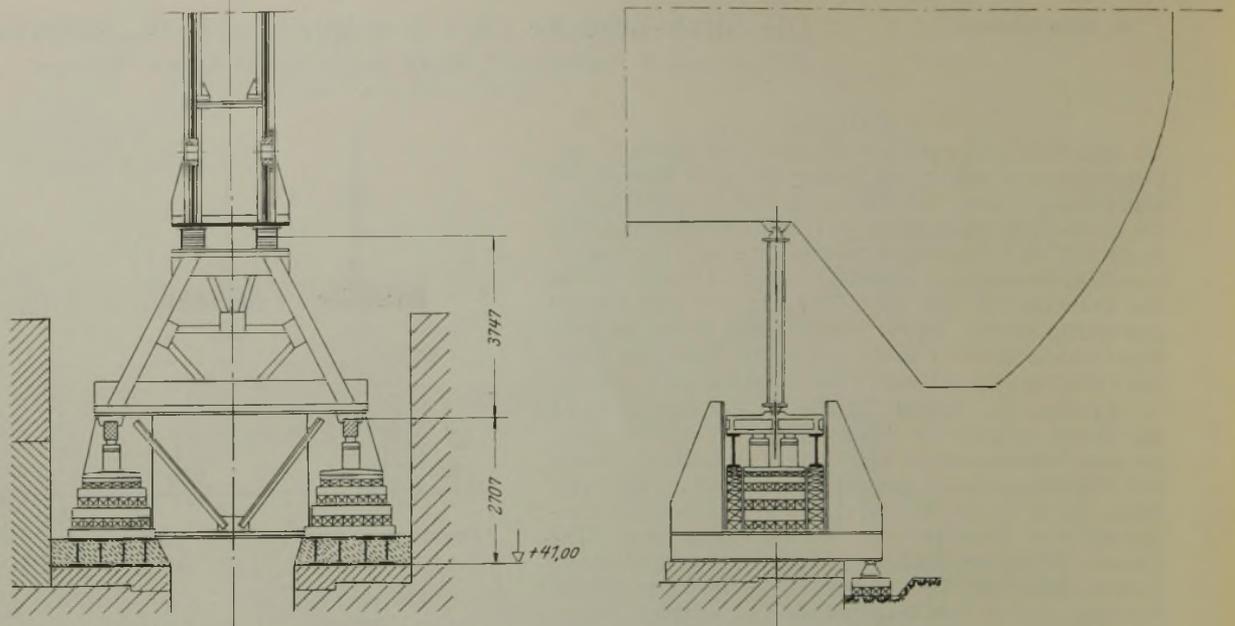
Abstützung des Versteifungsträgers am Ankerende nach dem Abbruch der Gerüste in den Seitenöffnungen.
